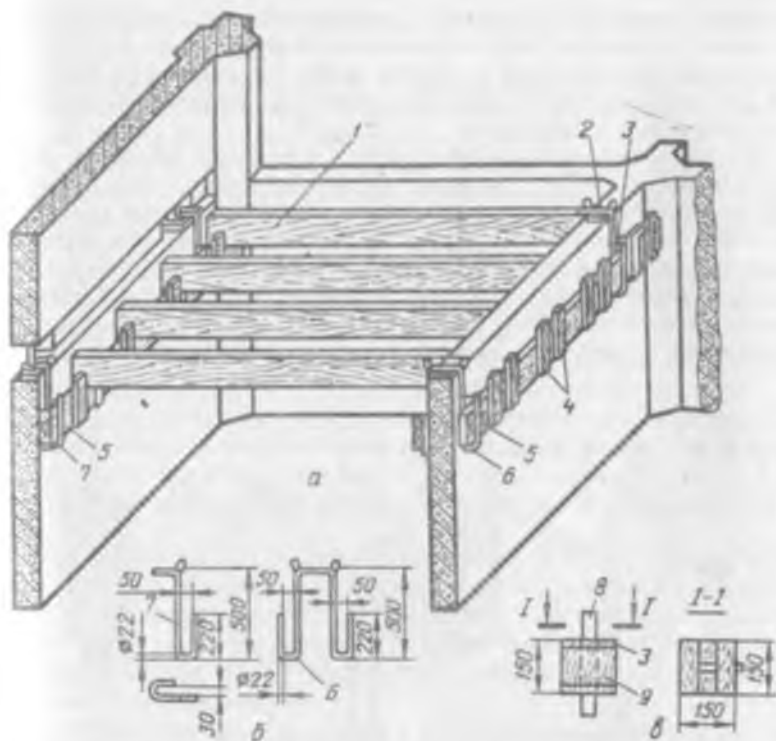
Устройство деревянной подвесной опалубки для перекрытия:
